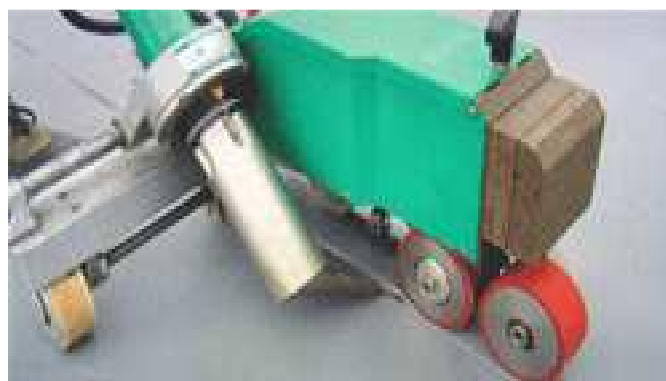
Зварювання полотнищ мембрани зварювальним апаратом
